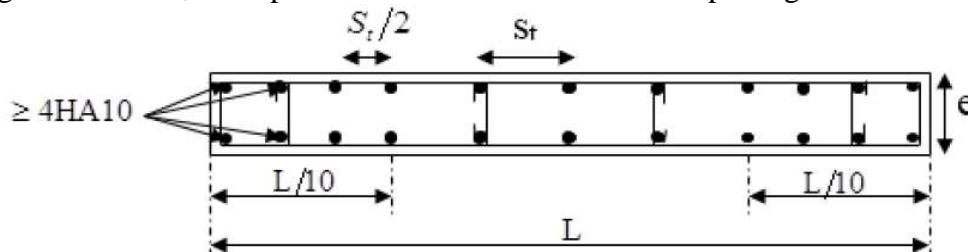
Disposition des Armatures verticales dans un voile.
